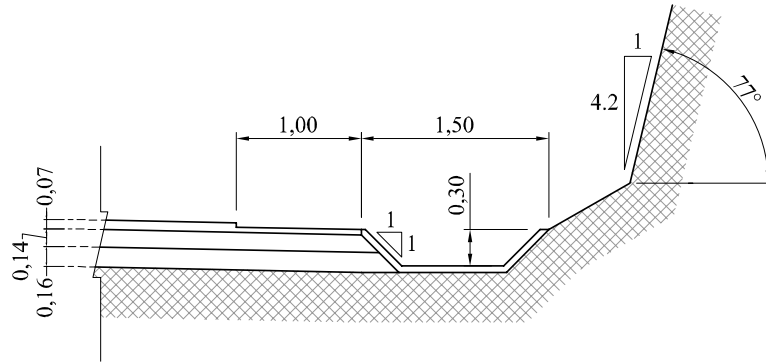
Detalhe da estrutura do pavimento e da sarjeta em concreto.
